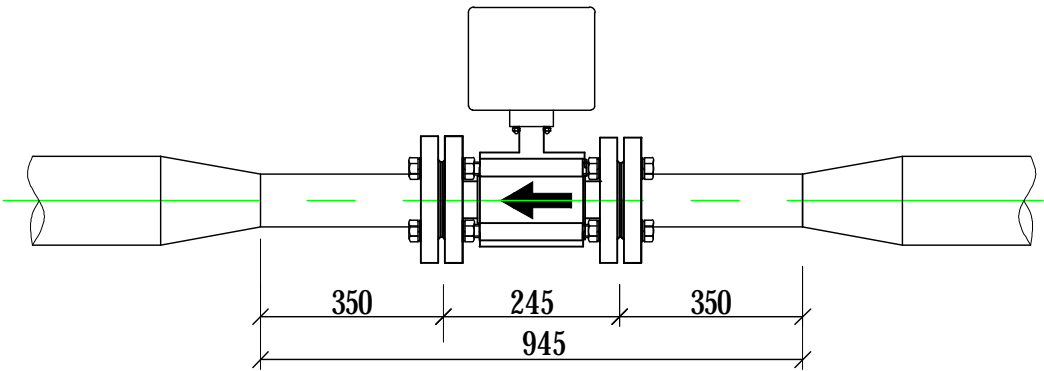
Расчетная схема для подающего трубопровода ГВС.
